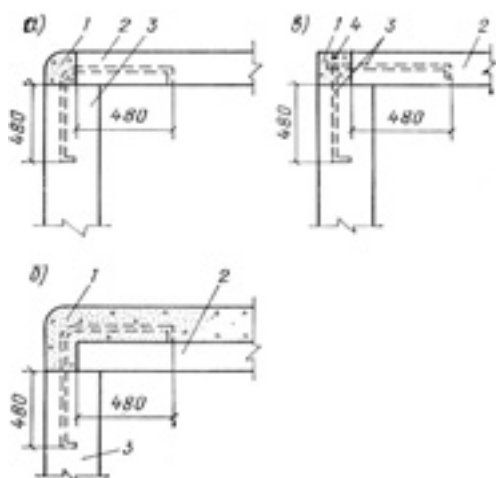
Анкеровка элементов перекрытия с наружными стенами: а – при сборном железобетонном перекрытии; б – при сборно-монолитном железобетонном перекрытии; в – при устройстве стен из длинномерных конструкций; 1 – слой монолитного бетона; 2 – элемент перекрытия; 3 – анкер 0–16 мм, заводимый в слой монолитного бетона через 1 м; 4 – стержень 0–20 мм, привариваемый к анкерам
